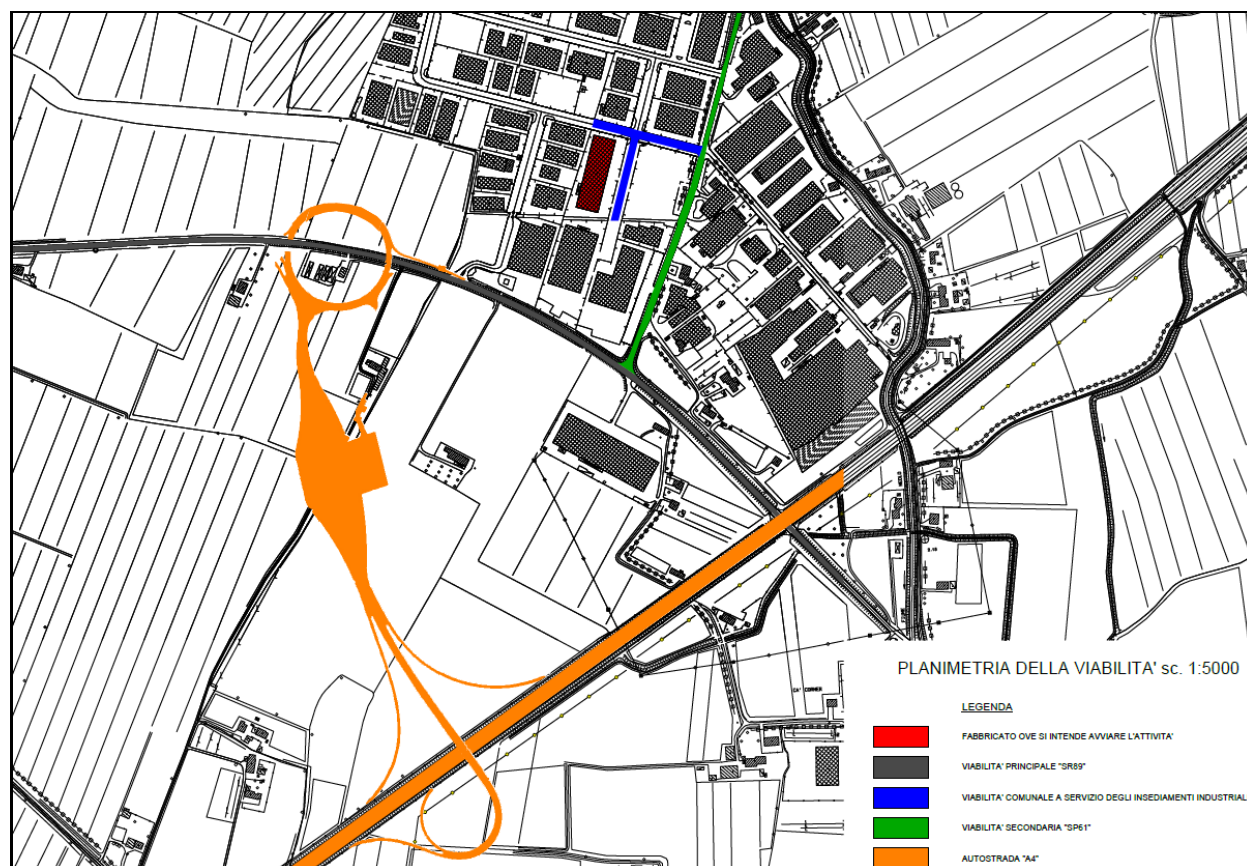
Estratto della Tavola 2 – Planimetria della viabilità
